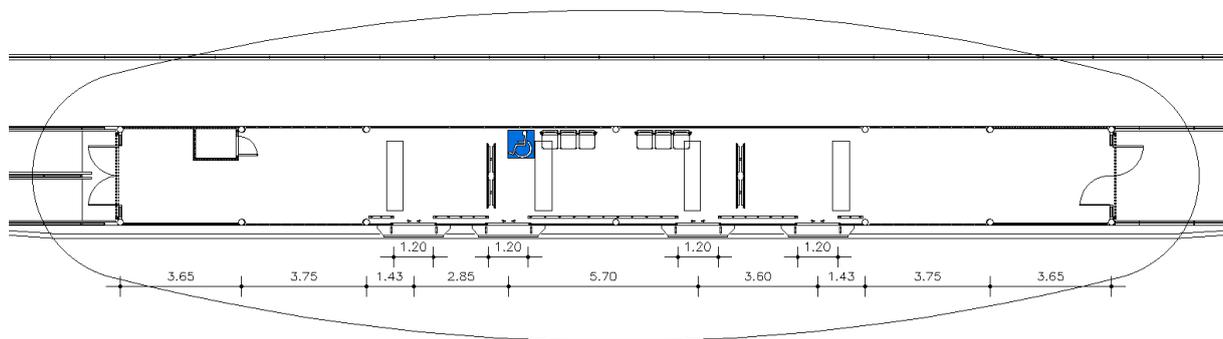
Planta da Estação de Passageiros na Avenida Almirante Barroso
